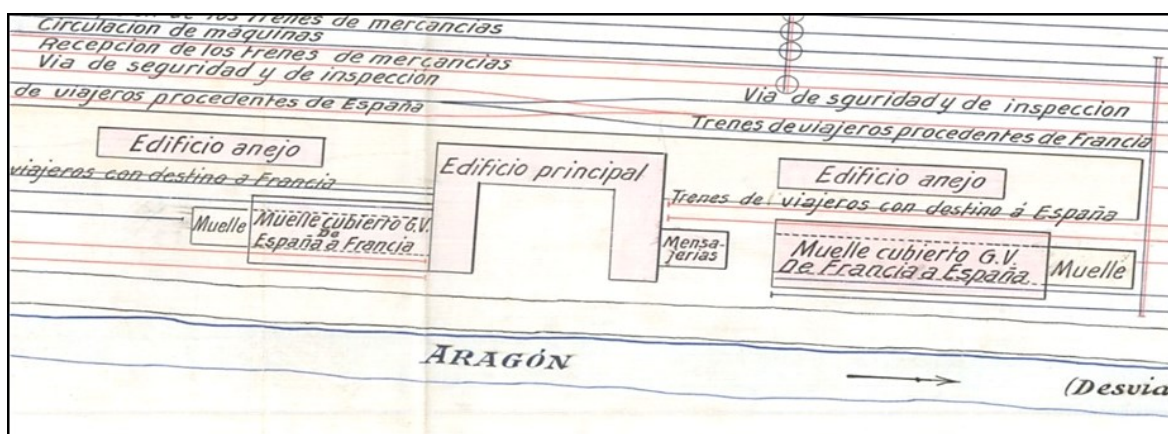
Detalle del primer plano de la estación de Canfranc elaborado en diciembre de 1910 por los ingenieros de las compañías explotadoras Norte y Midi, José Moreno y Charles Guffel, con una distribución y planta similar a otras estaciones de Norte como la de Valladolid, con los brazos del edificio principal muy proyectados hacia adelante. AGA, Caja 25/0821, Anexo I.
